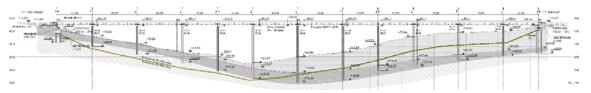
Perfil Longitudinal de Puente sobre el Río Negro
